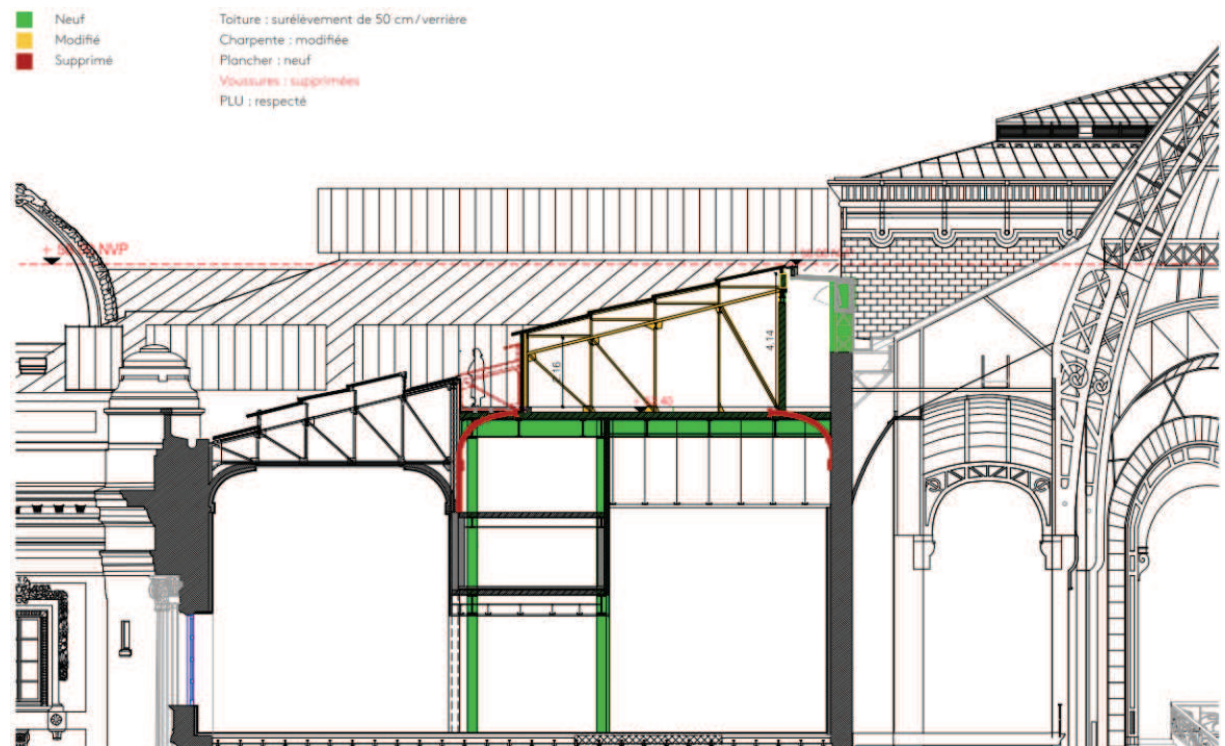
Projet de l'aménagement de la terrasse sur le toit du bâtiment intermédiaire Sud © LAN
